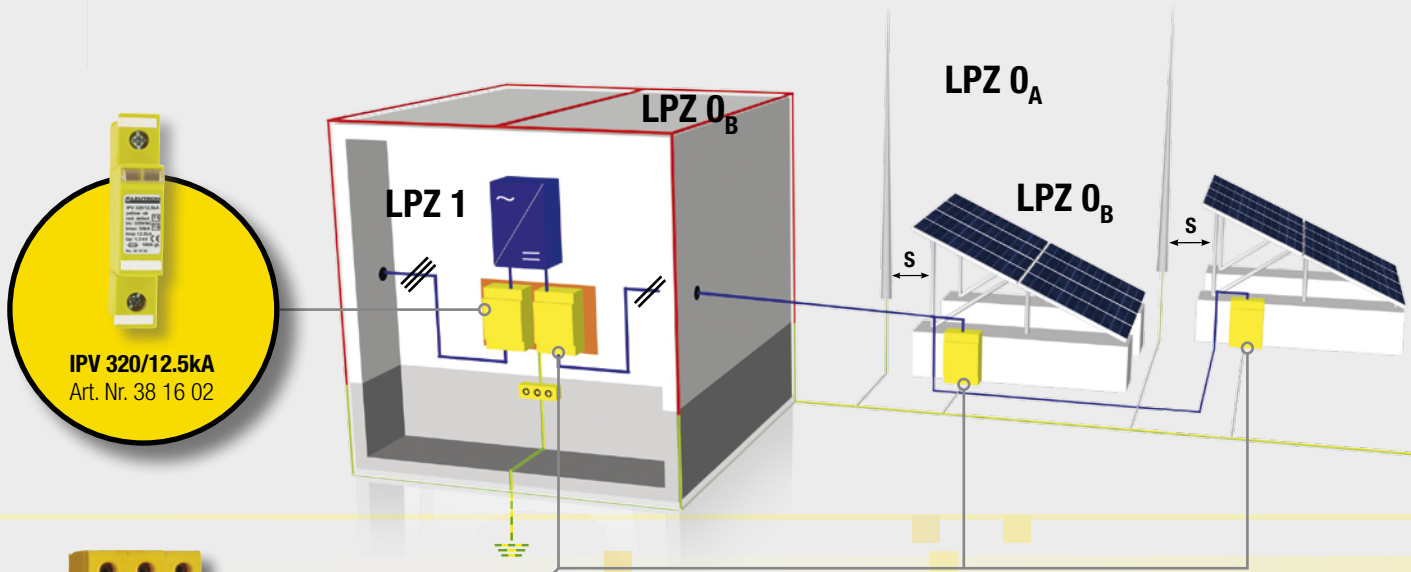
Gebäudeinstallation mit äußerer Blitzschutzanlage und Einhaltung des Trennungsabstands.
